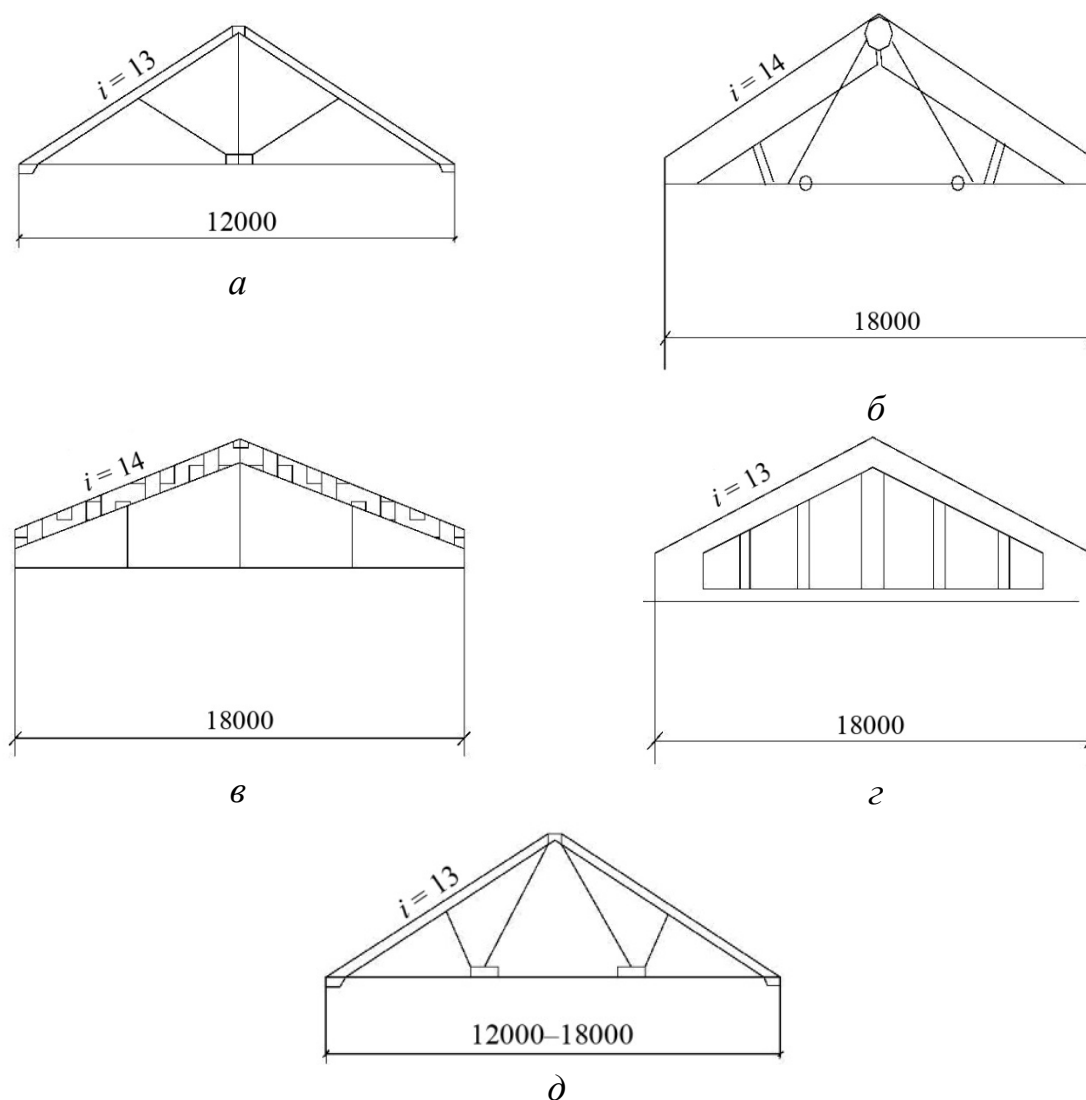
Несущие конструкции ферм покрытия зданий:
